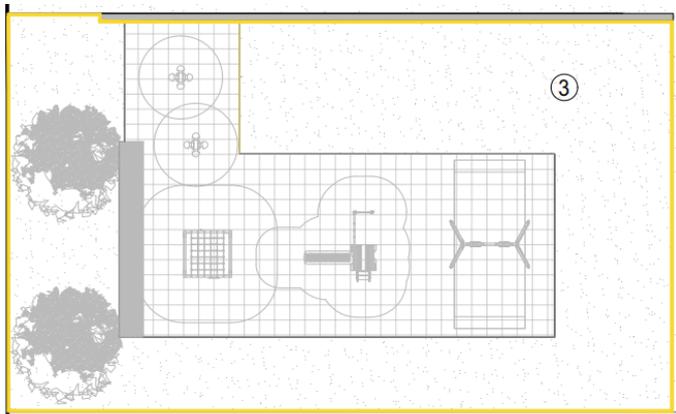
Planta da situação existente (PI 3) | Fonte: autora, 2023 | sem escala
